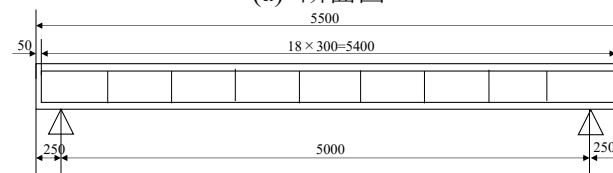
に供試体の側面図と断面図を示す。支承は H 鋼上に鉄板を敷いた。今回は H 鋼下にゴム板の有無による 2 パターンで振動測定を行った。対象とした供試体の RC 梁の長さは 5.5 m、単純梁としての支間長は 5 m である。供試体は過去に曲げ載荷を行っており、側面や底面に曲げクラックが入っている。図-2 に 2020 年 12 月 26 日でのひび割れ状況を示す。中心部にかけて複数のクラックが確認されており、曲げクラックが確認された。
